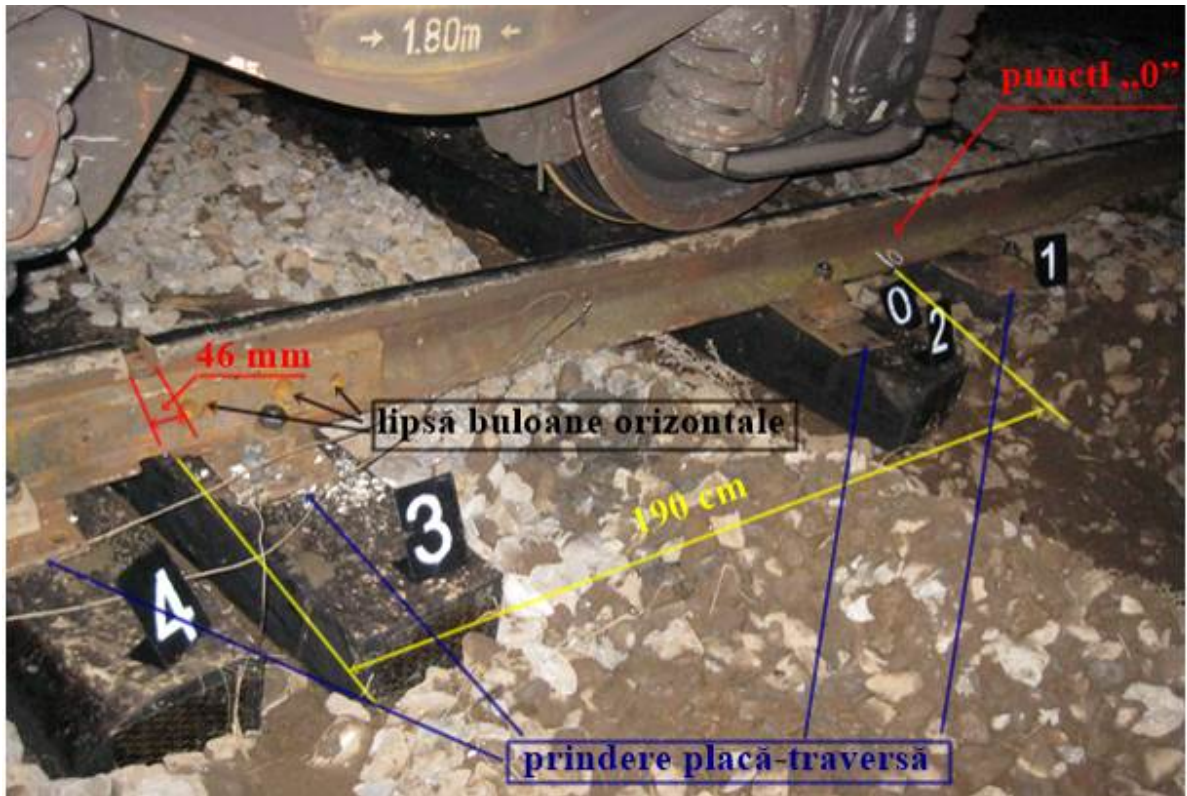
poziția punctului 0 față de ultima joantă a schimbătorului de cale nr. 4
